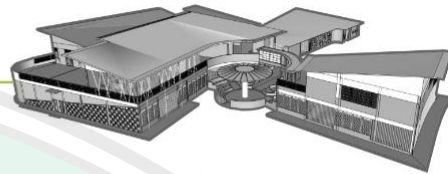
Hasil Rancangan Ruang dan Bentuk Bangunan
